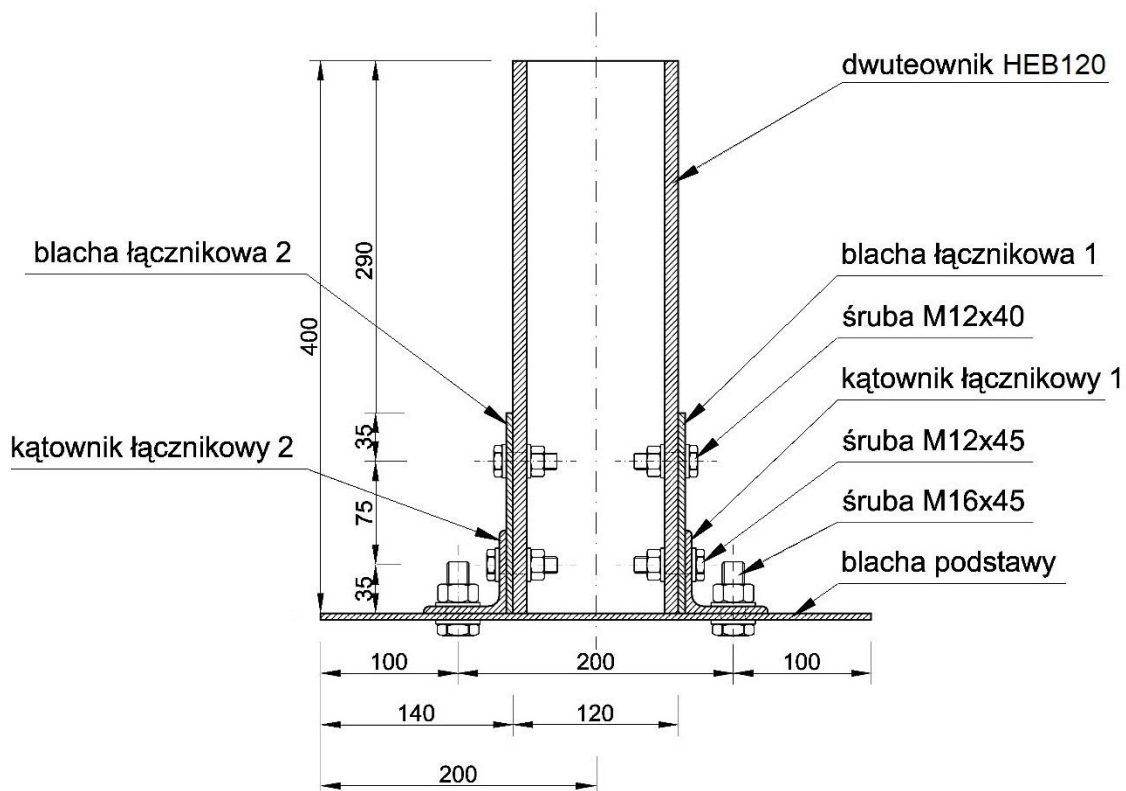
Układ elementów po zmontowaniu – widok z boku
